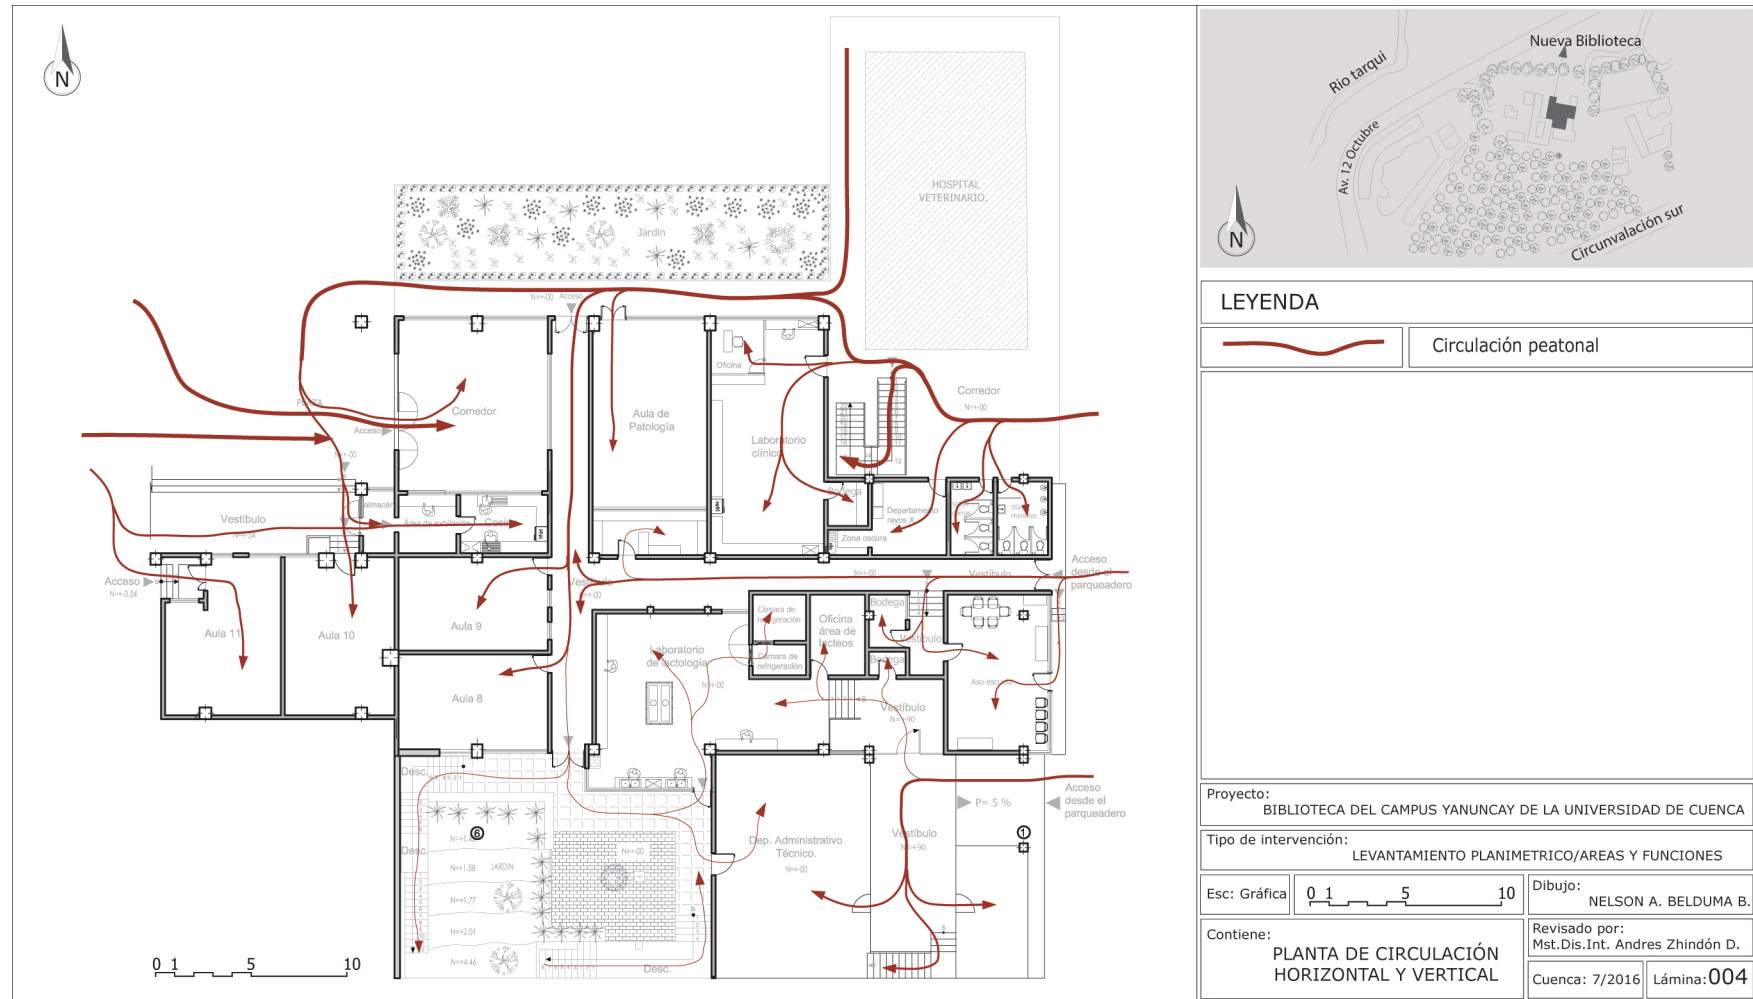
Planta de circulación horizontal y vertical estado actual. De las áreas que se emplazará la nueva biblioteca.
